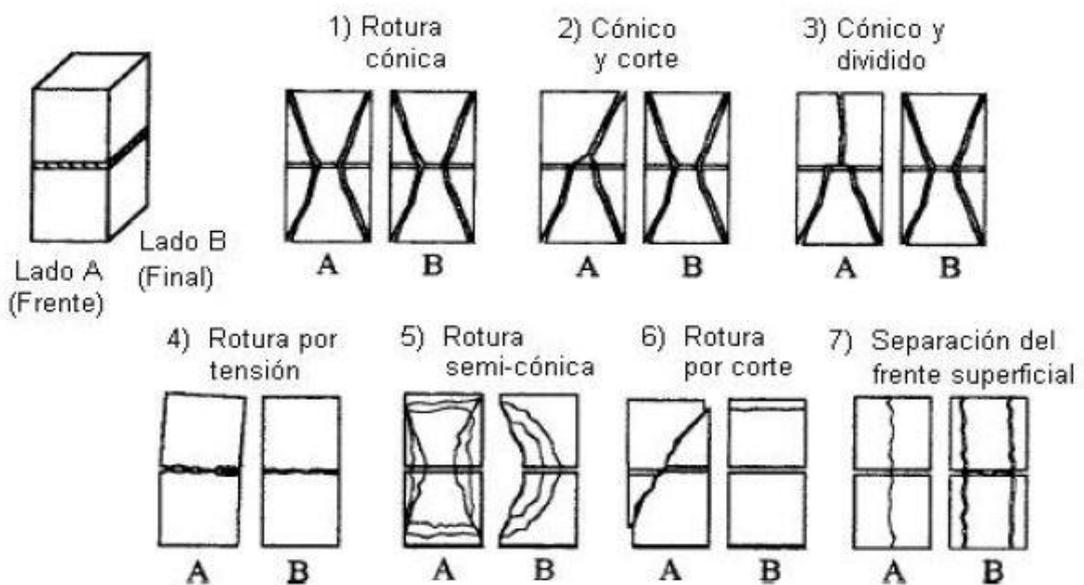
Tipos de fallas en pilas de albañilería. (Fuente: NTP 399.605)
